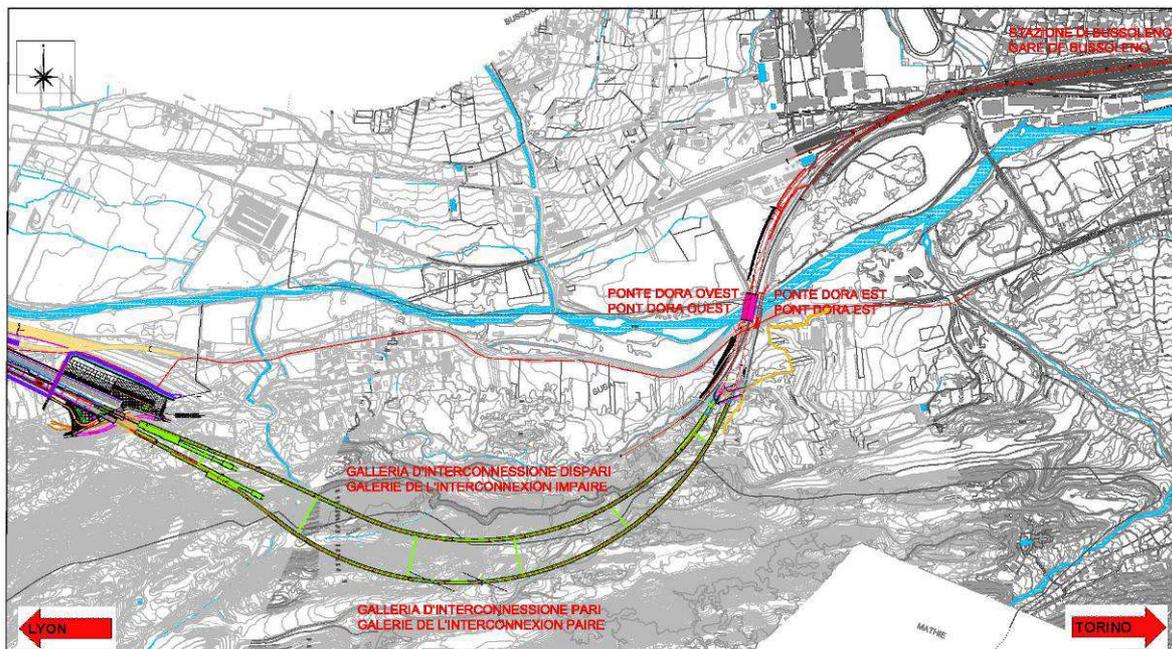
Planimetria generale interconnessione e dell'ingresso nella stazione di Bussoleno
